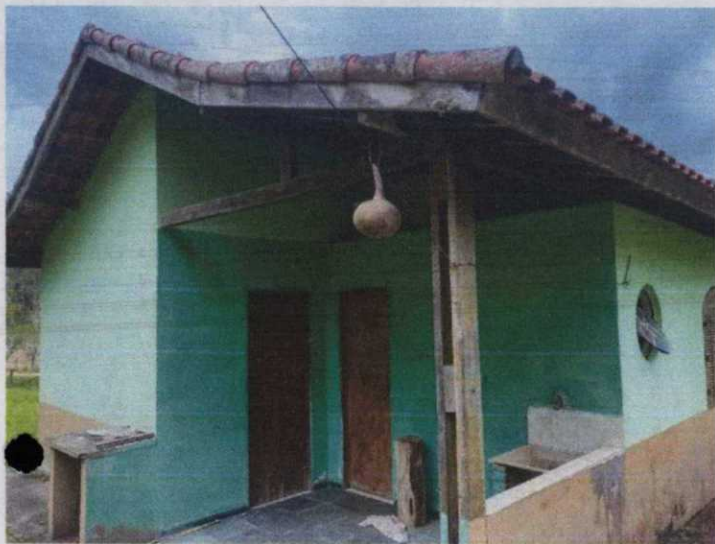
IMAGEM – CASA DE CASEIRO (BANHEIRO EXTERNO)
